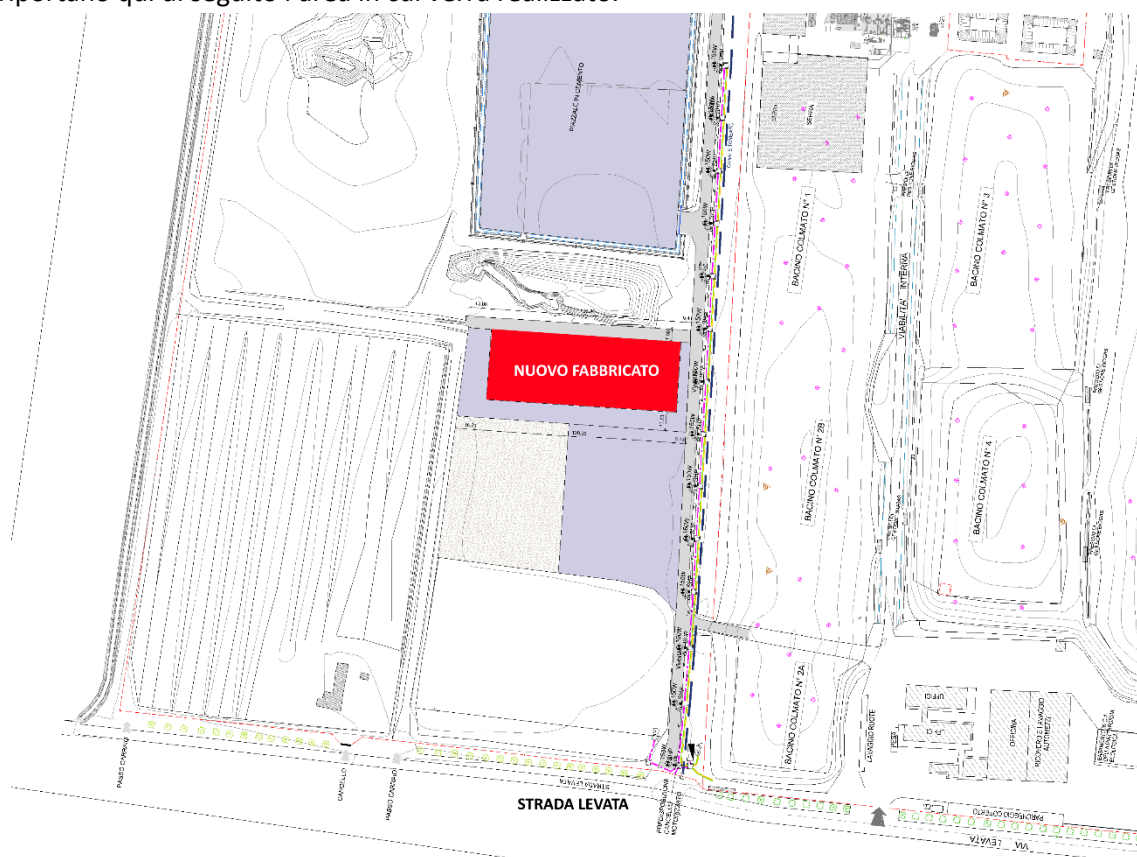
Localizzazione in pianta del nuovo fabbricato
